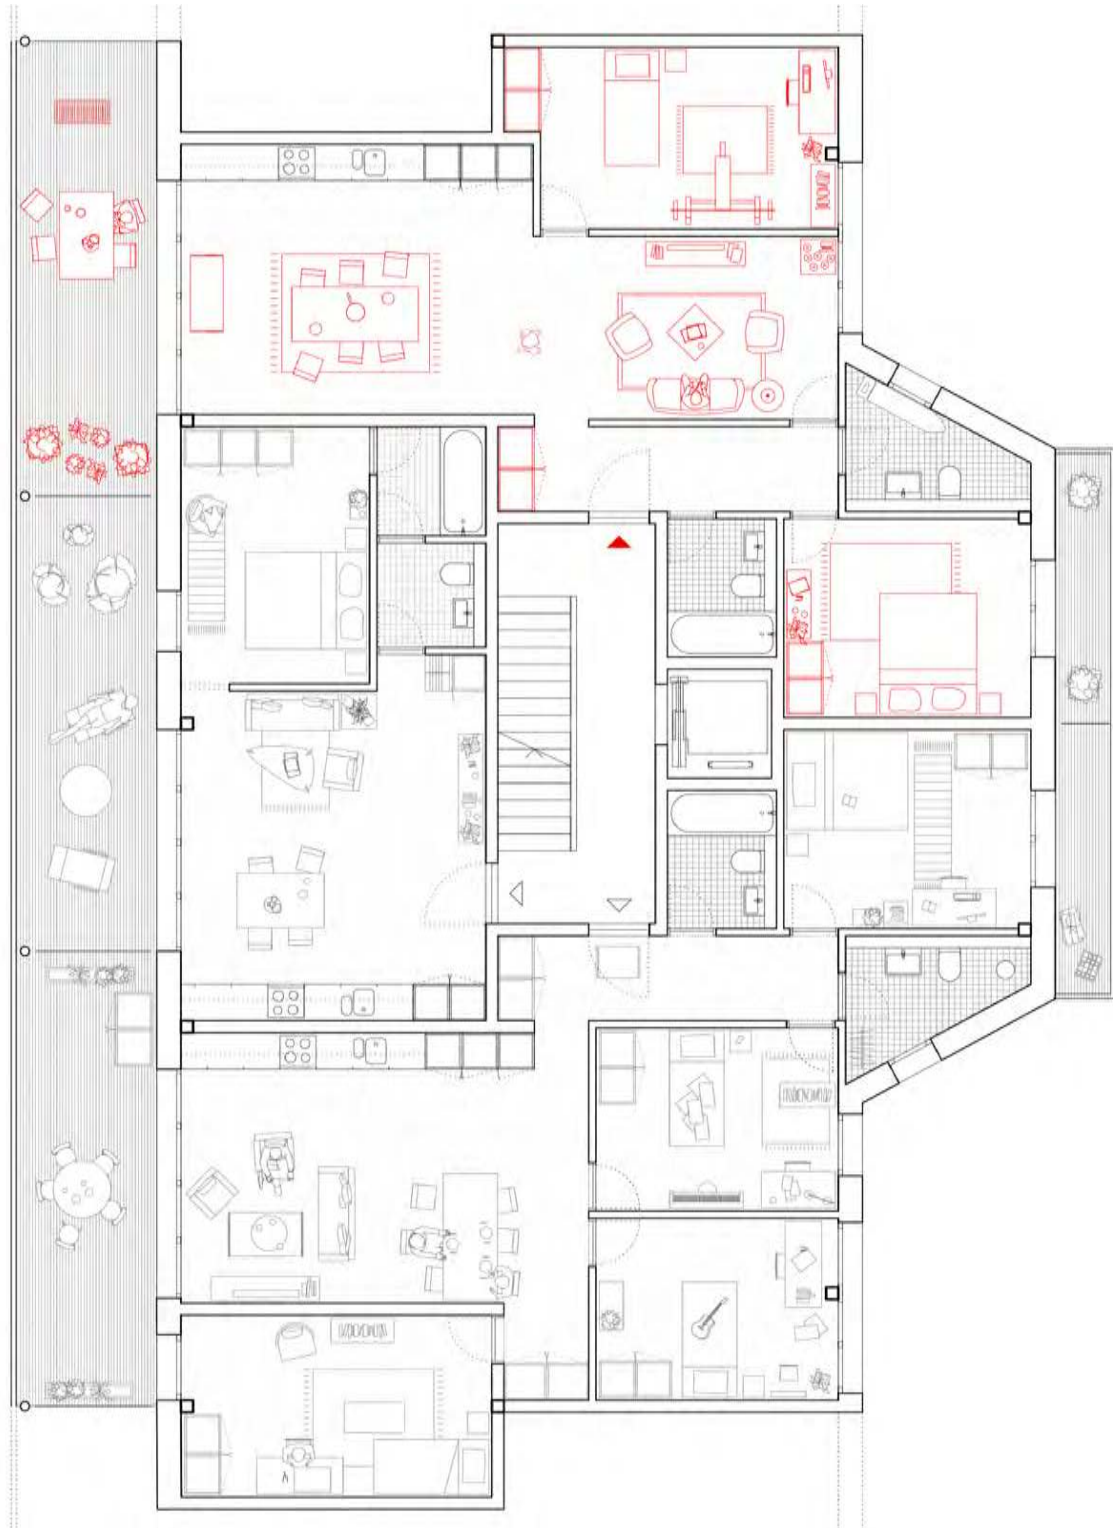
Stadtweiler: Wohnungsgrundrisse
